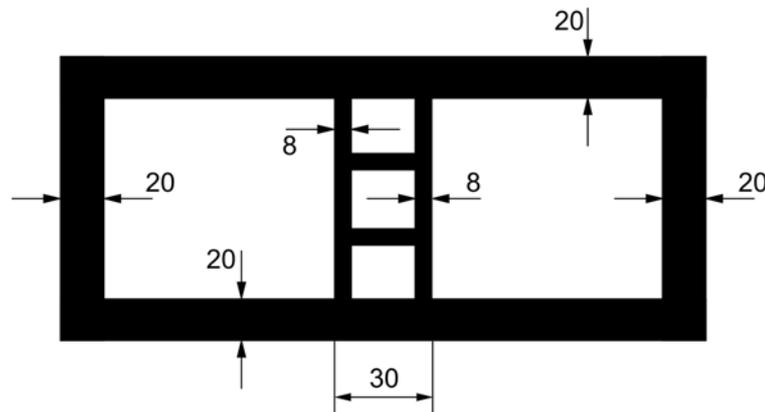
Planta do bloco estrutural vazado com paredes maciças
